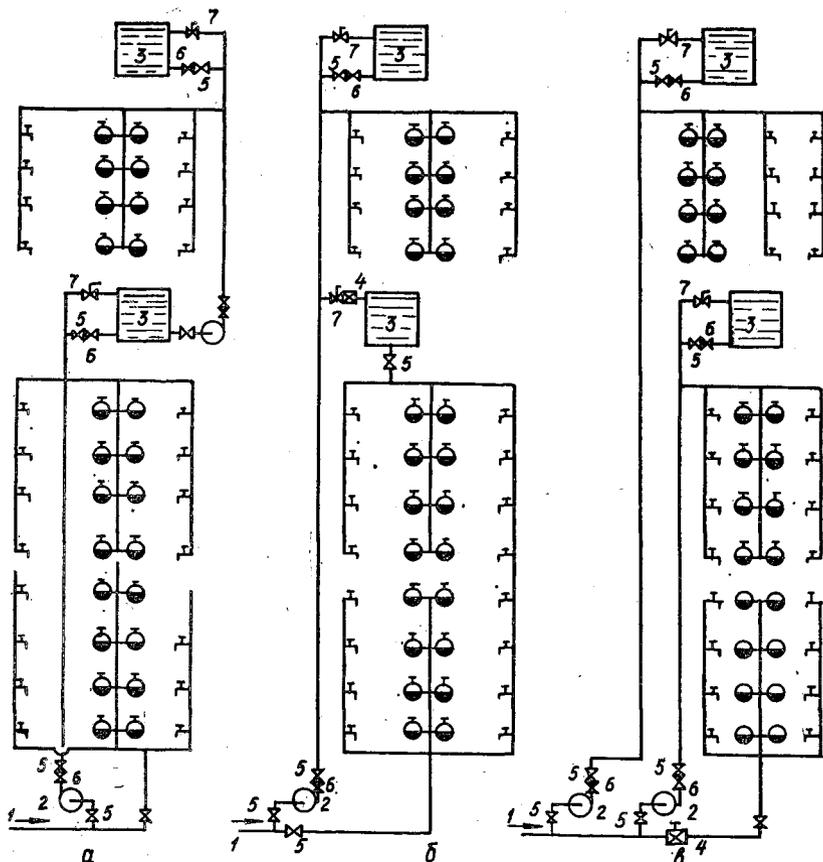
Схемы зонного водоснабжения многоэтажных зданий по схемам подачи воды:
